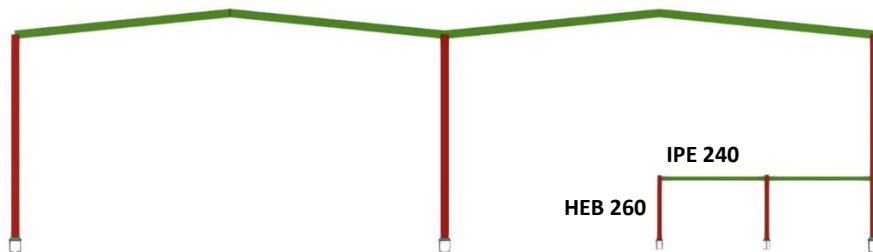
Pórtico interior con altillo. Fuente: CYPE 3D.
